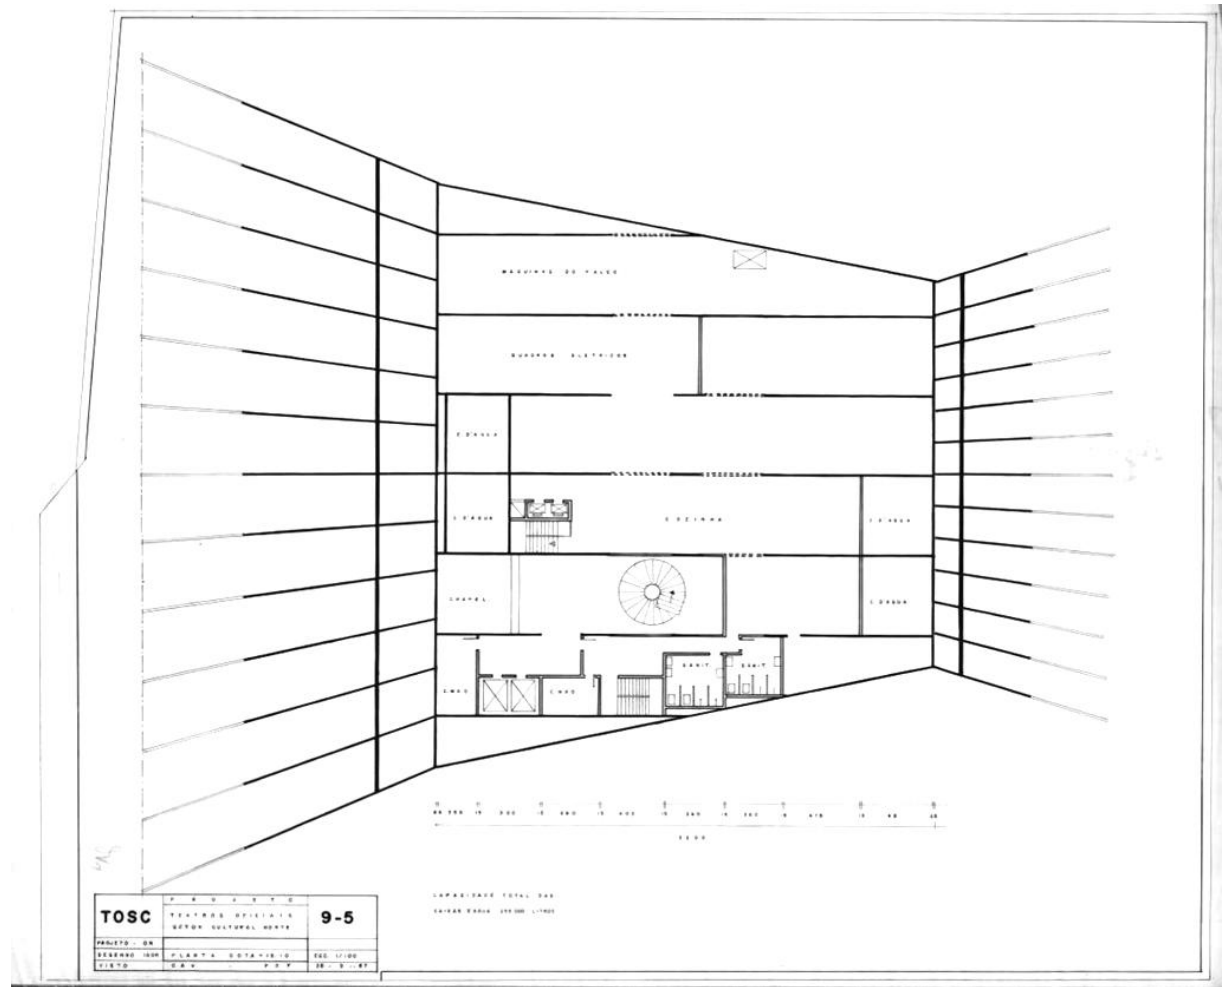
Planta Baixa, 3º Pavimento (1967). Carimbo: Teatros Oficiais Setor Cultural Norte, TOSC, 9-5. Conteúdo: Planta cota +18,10. Desenhista: Igor. Fonte: ARPDF.
